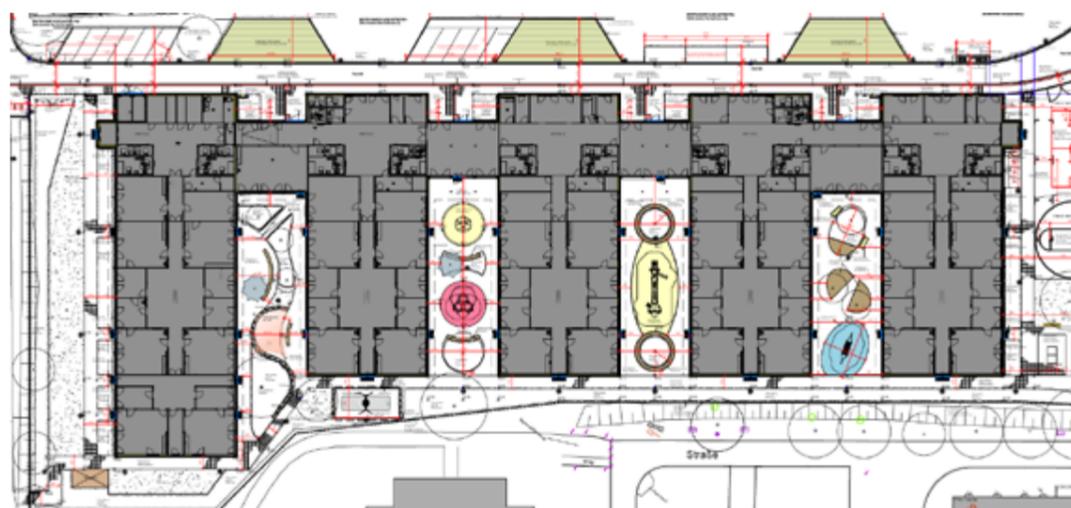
Grundrisskonzept 1.BA der Paul-Klee-Schule
